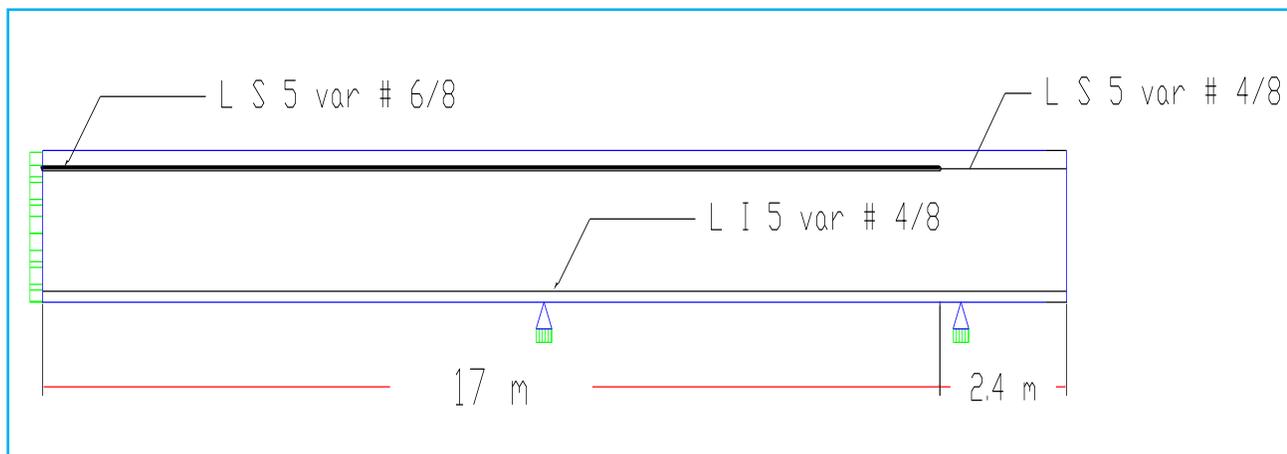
breve esquema de las longitudes de las varillas en la trabe.
